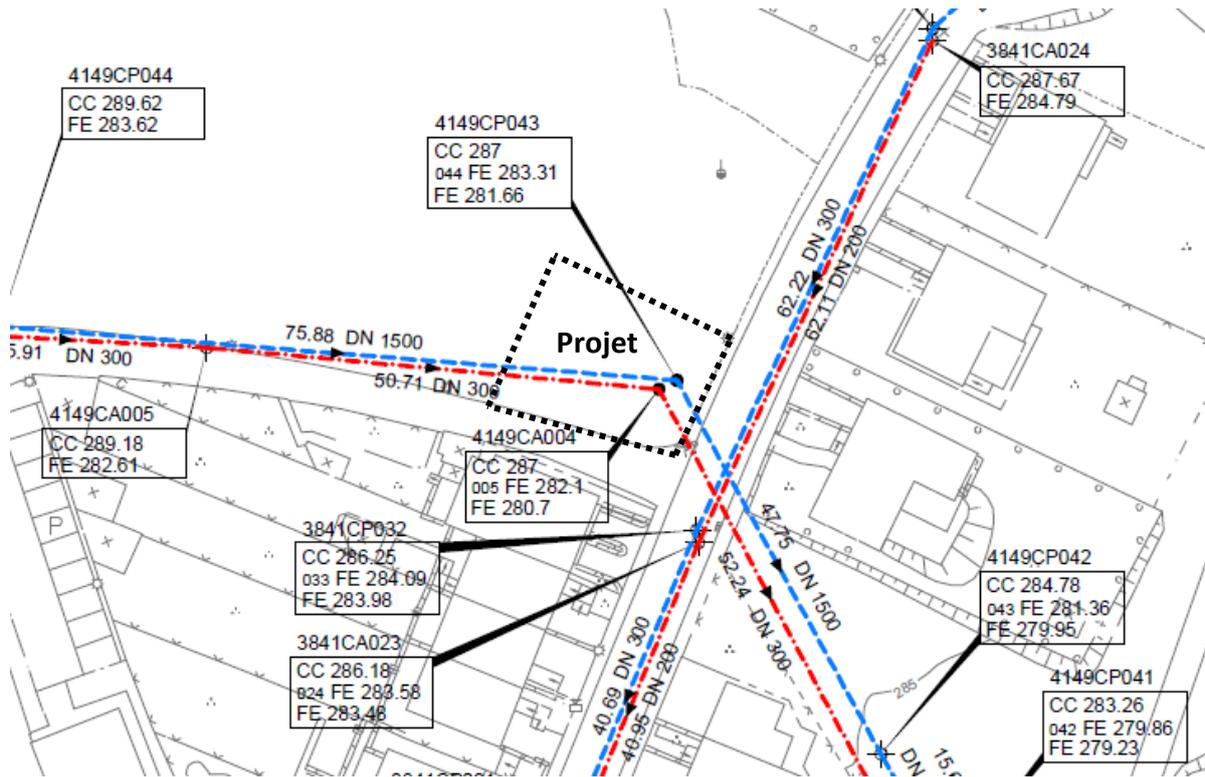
Plan du réseau communal des canalisations – situation Schifflange, réf. : T-103 du 07.2014 (Source : Schroeder&Associés)
